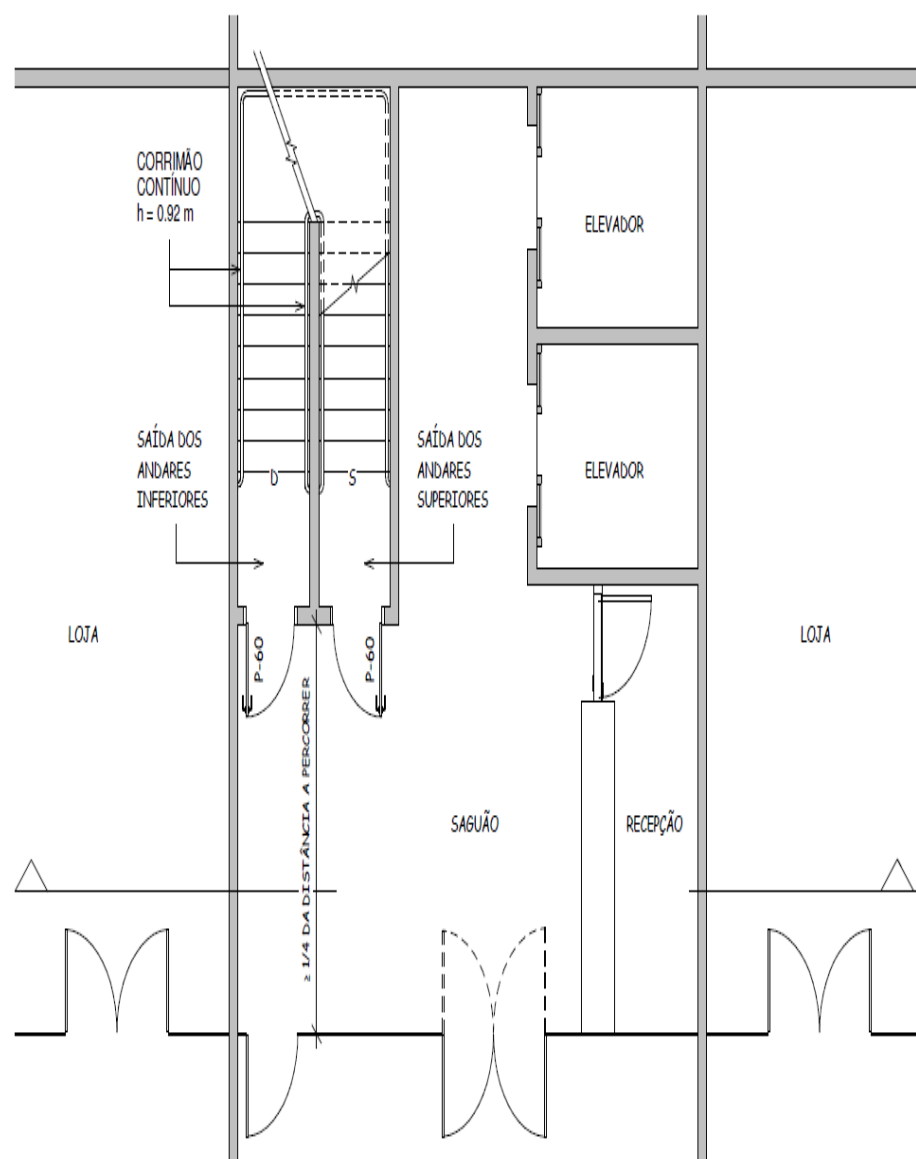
A - Descarga com independência entre pavimentos (planta baixa).
